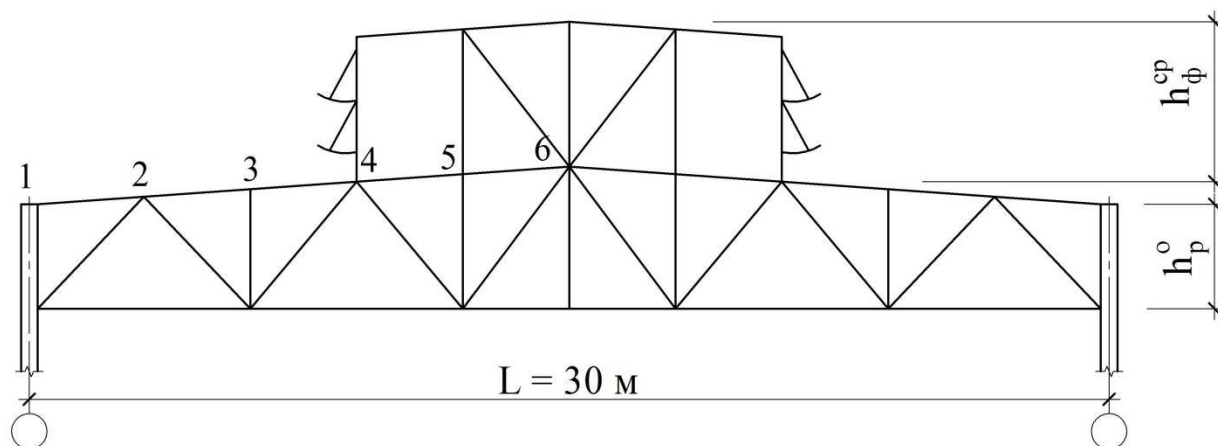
Схема ригеля к определению узловых нагрузок
